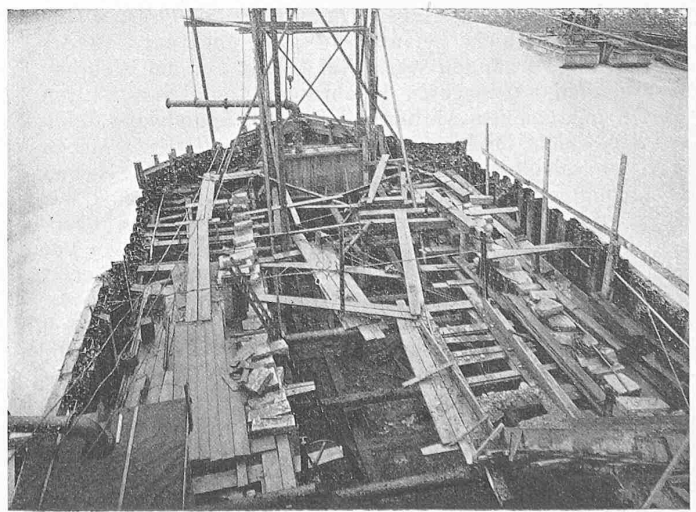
Offene Baugrube mit Larssen-Spundwänden (10. VII. 1917).
